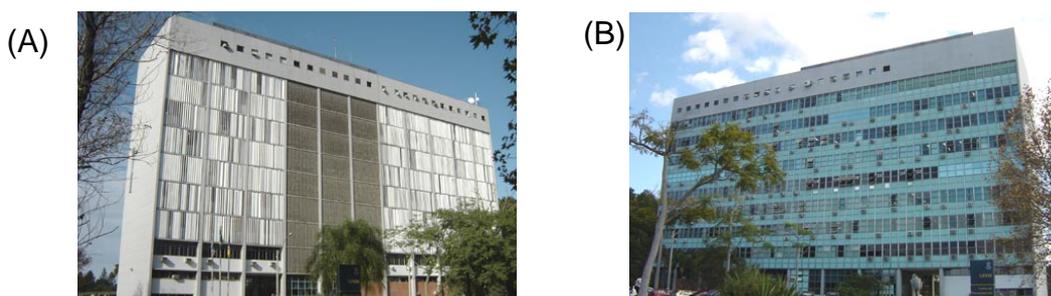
Vista externa - (A) fachada Oeste (B) fachada Leste
